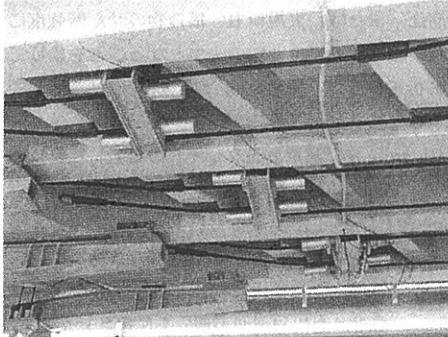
CFRPケーブル施工状況 (P2-P3区間)
